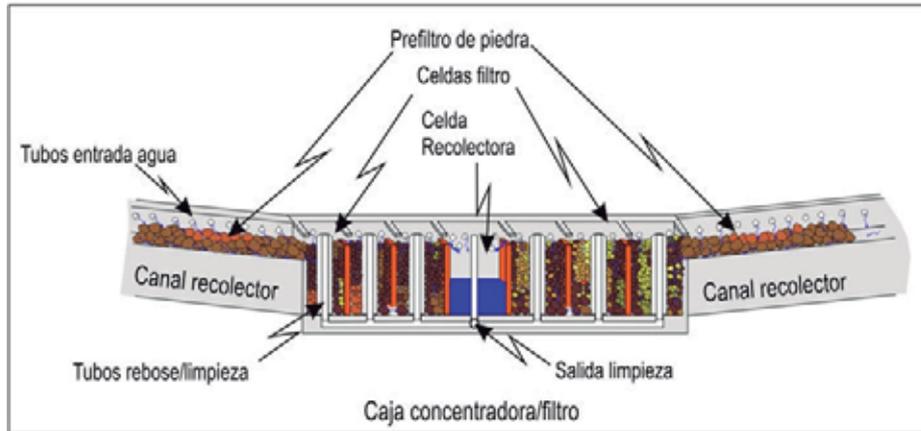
Esquema de la captación en sección longitudinal con el detalle de caja concentradora/filtro.
